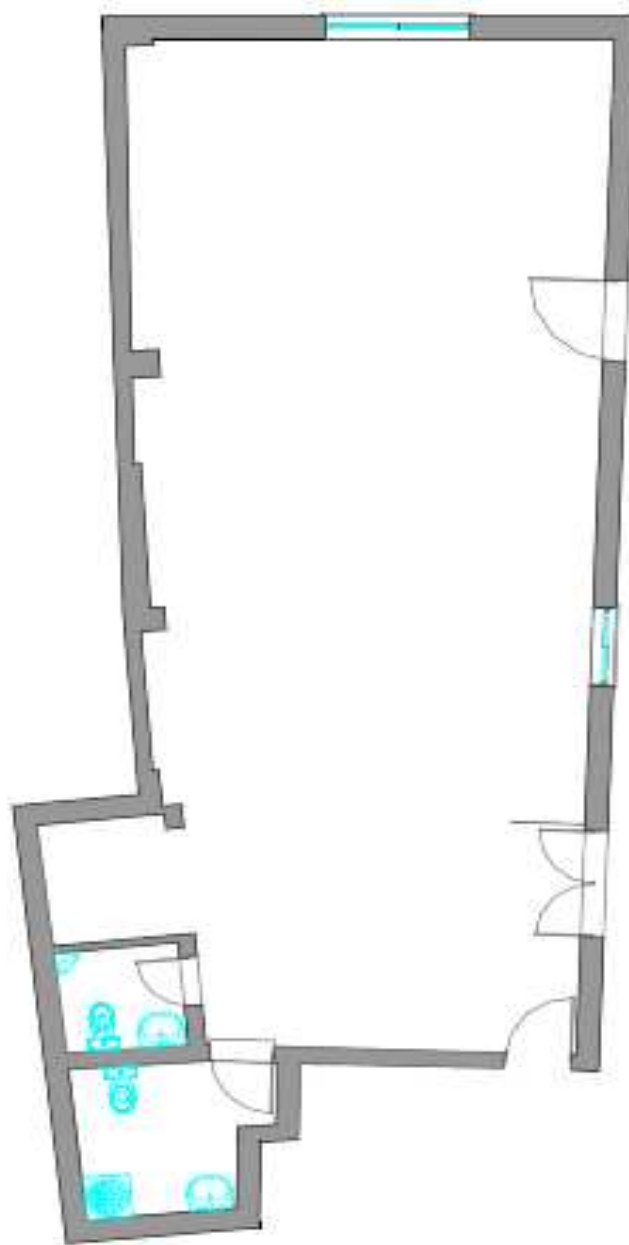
Adaptado da planta do snack-bar (Ponto de Vista A)
